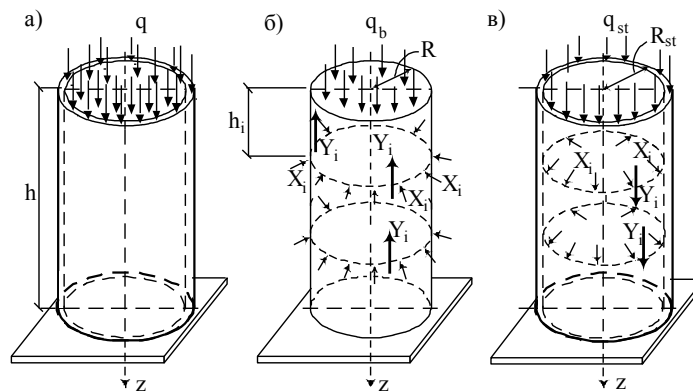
Розрахункова схема консольної сталобетонної колони: а – колона; б – бетонне ядро радіуса R_c ; в – сталеві обійми зовнішнього радіуса R_s
